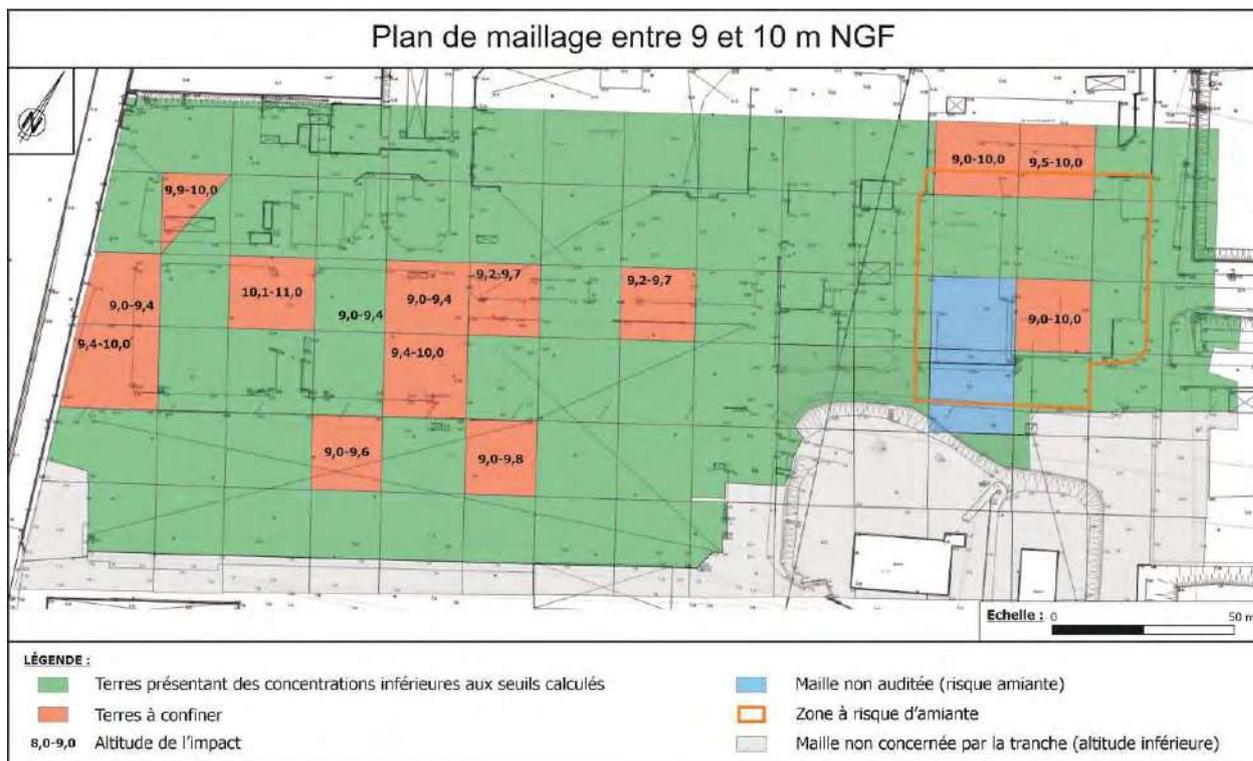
Plan de maillage entre 9 et 10 m NGF
